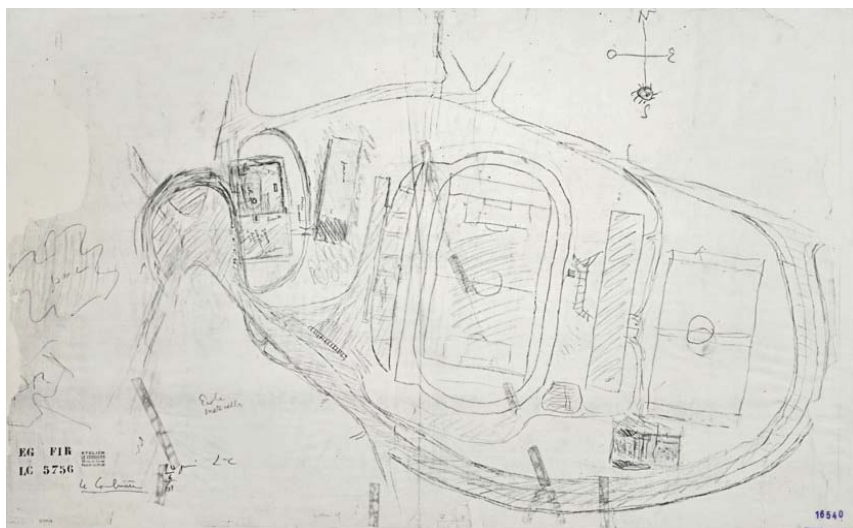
Dibujo del emplazamiento de la primera versión. Fuente: FLC. 16540
